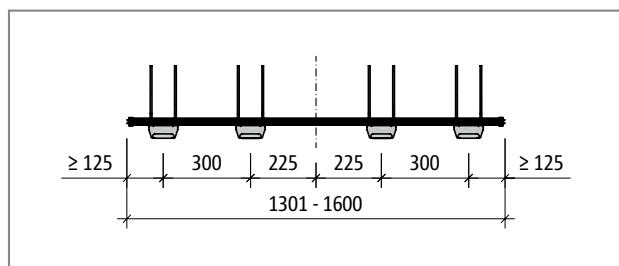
Schöck Tronsole® tipo T-V4-H...-L1301 - L1600, pianta del prodotto
